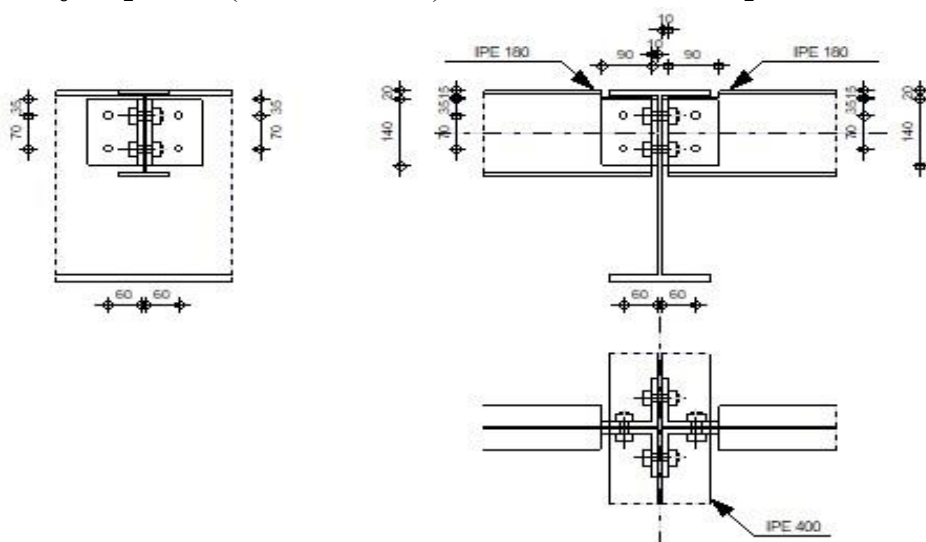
Disposition constructif de l'assemblage poutre – solive.
